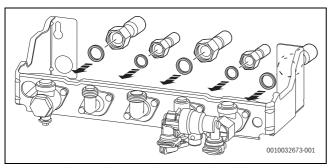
Instalar os tubos com vedações na placa de ligação para montagem
